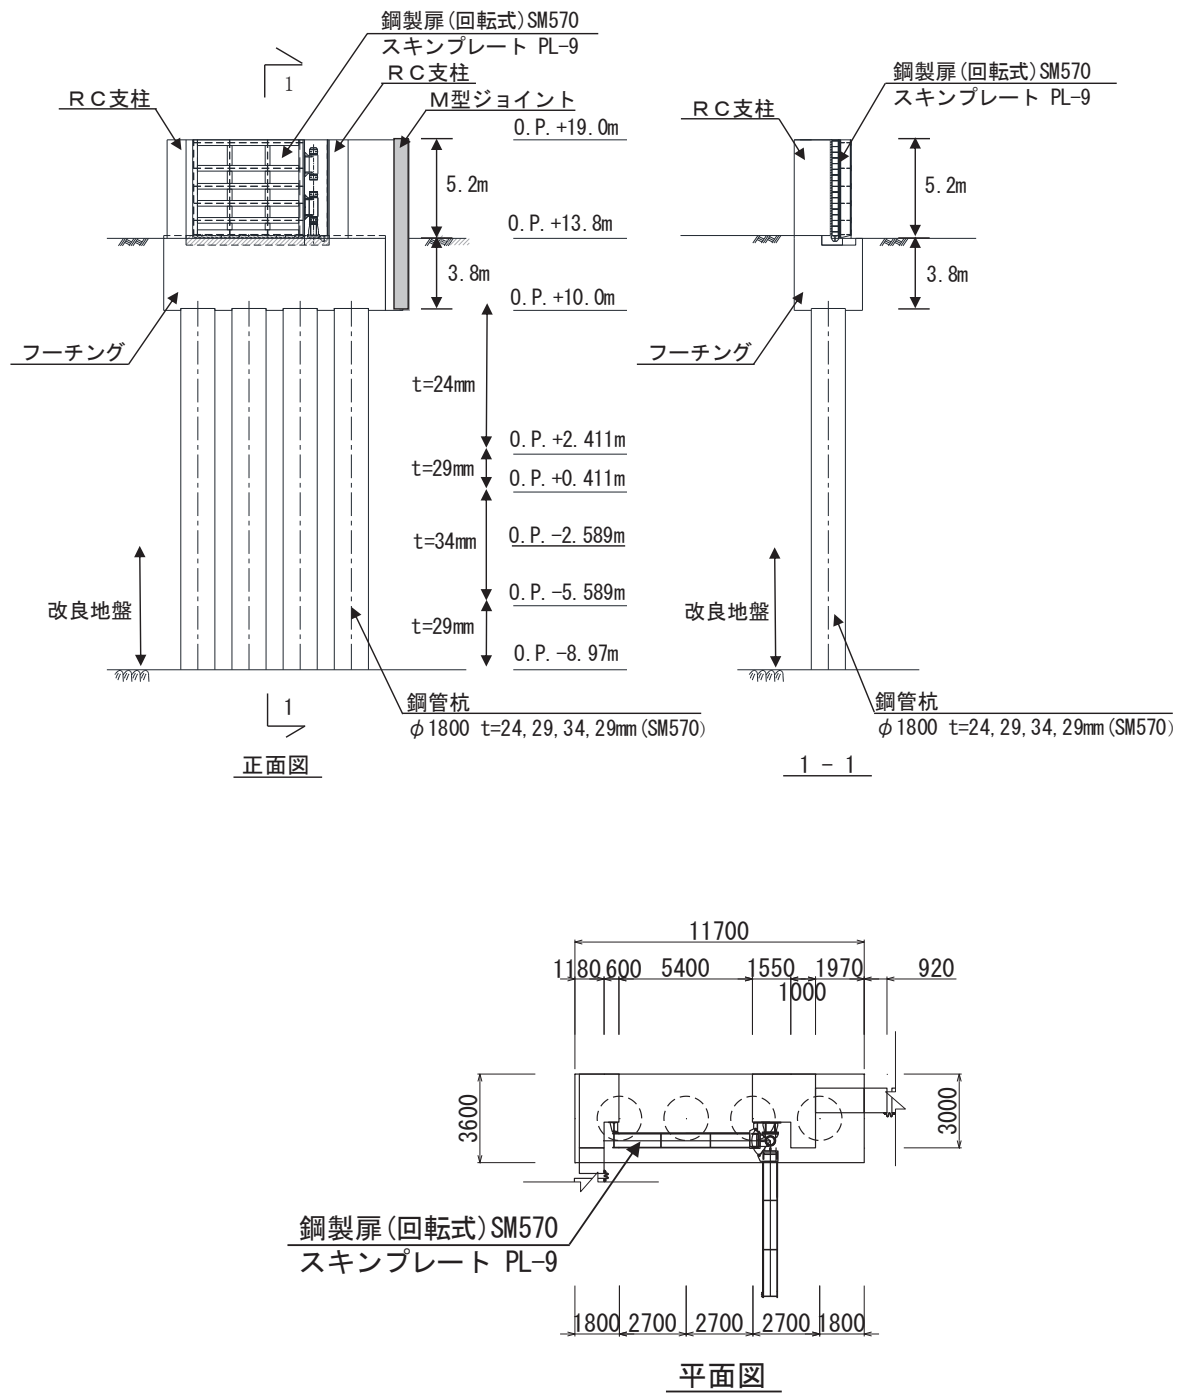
鋼製扉 1 の構造図 (正面図及び断面図, 平面図)
